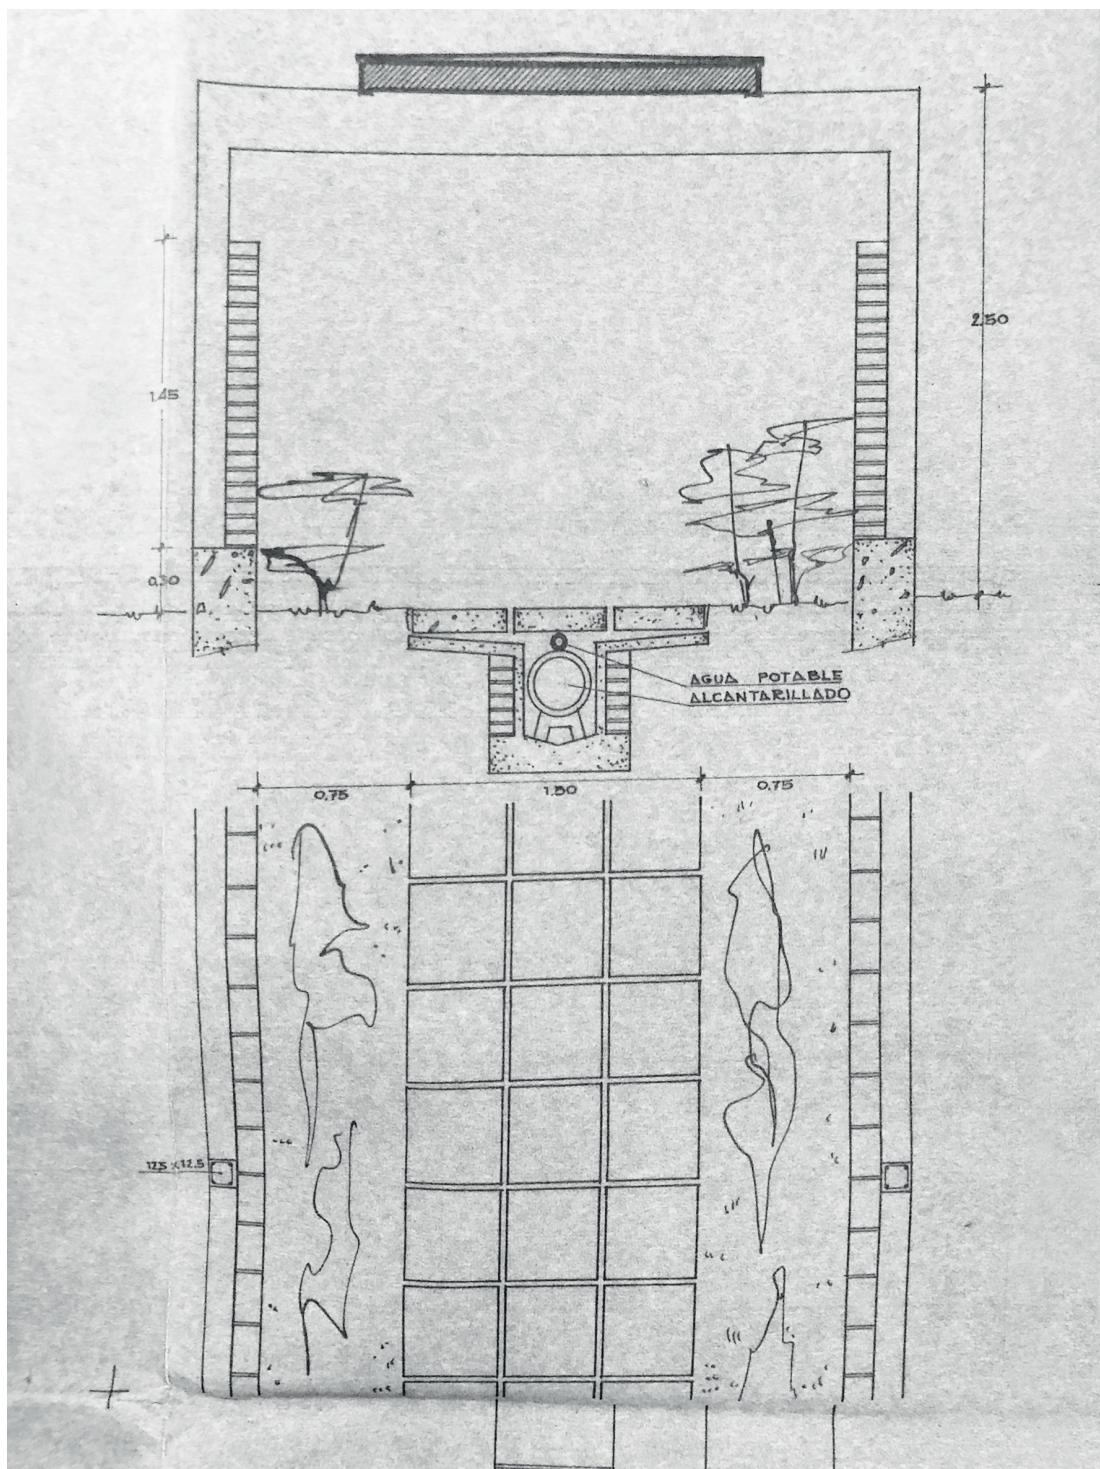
Poblado de Aguilar de Campoo (1962-64). Sección y planta constructiva del paso cubierto.
